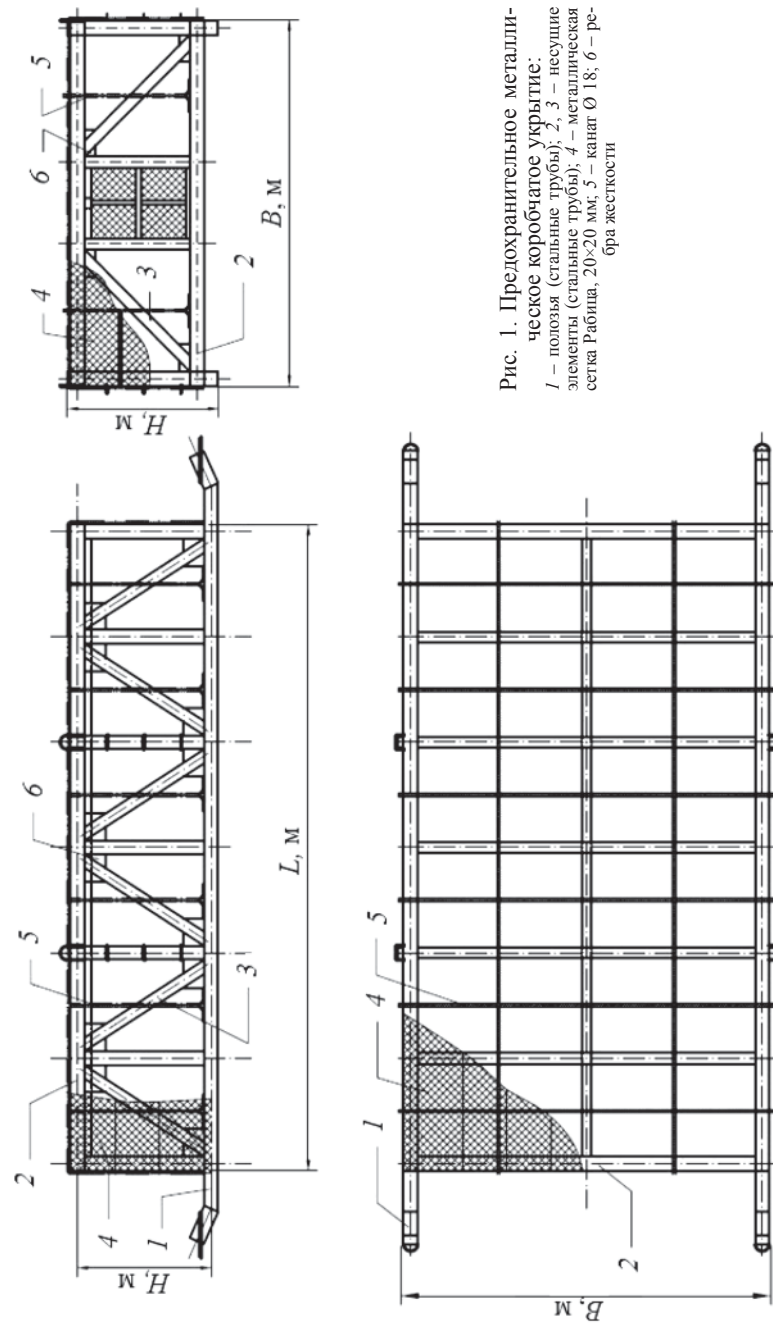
Предохранительное металлическое коробчатое укрытие:
